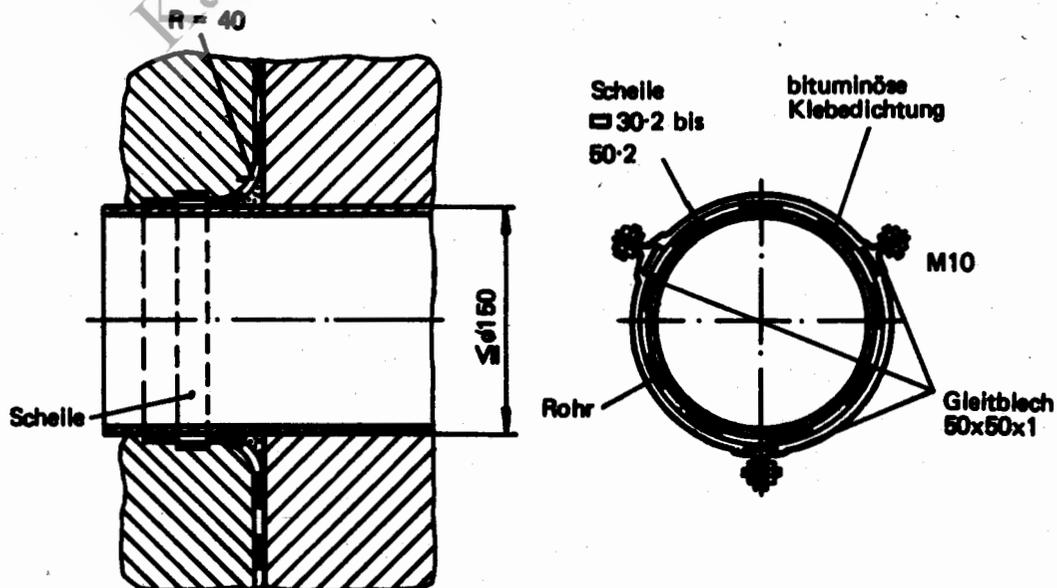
Rohreindichtung mit Manschette und dreiteiliger Schelle
